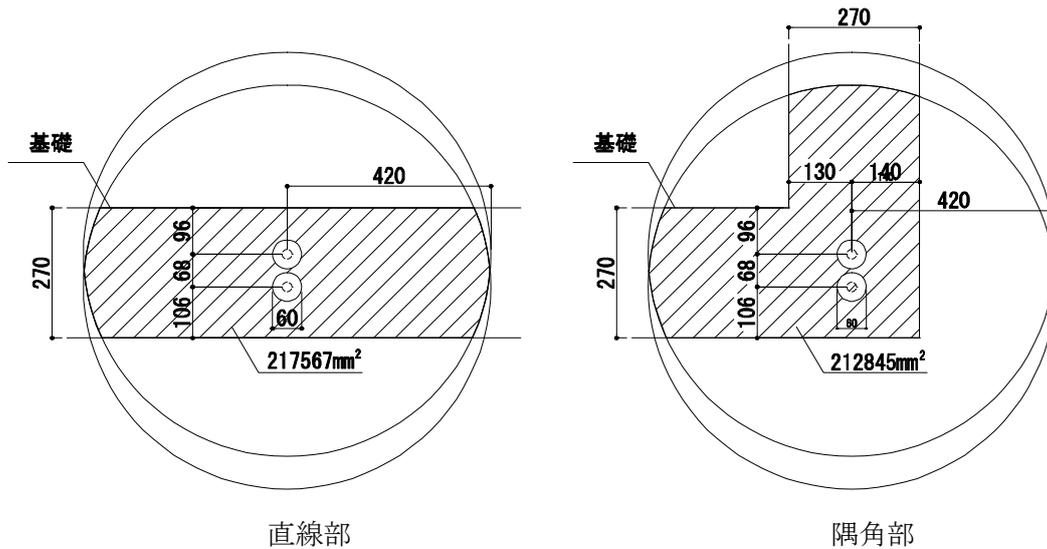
アンカーボルトのコーン状破壊面の有効水平投影面積
